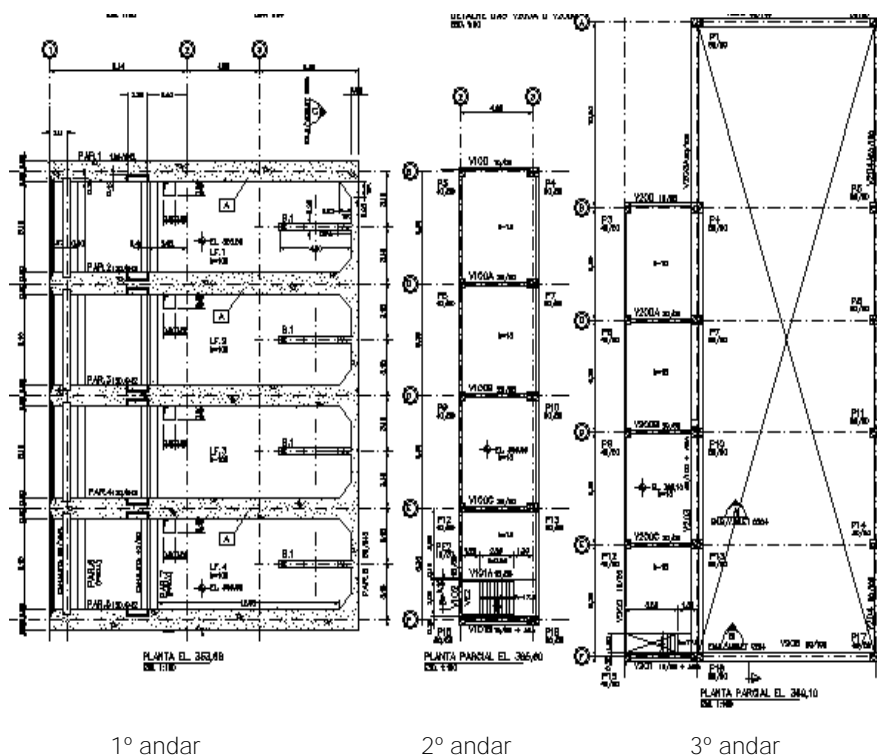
Estação de bombeamento - planta típica - 1º, 2º e 3º pavimentos
